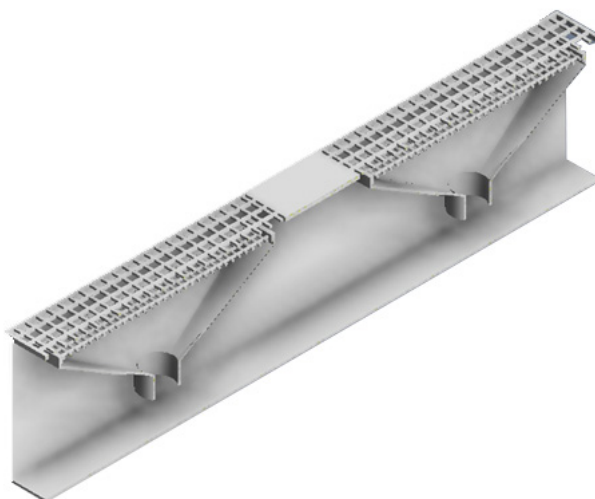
Sezione assonometrica laterale bocchette 160 cm x 30 cm e cavedio.
